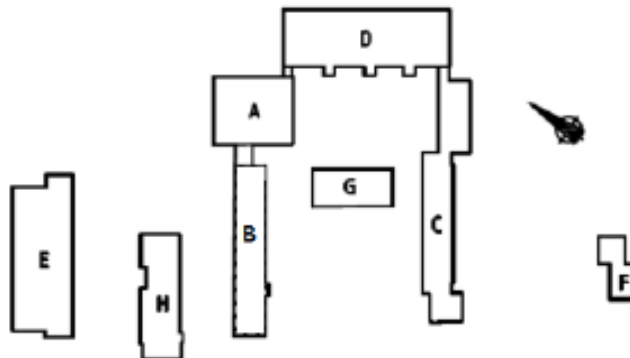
Översiktlig plan för byggnader vid Bäckahagens skola innan projekt
